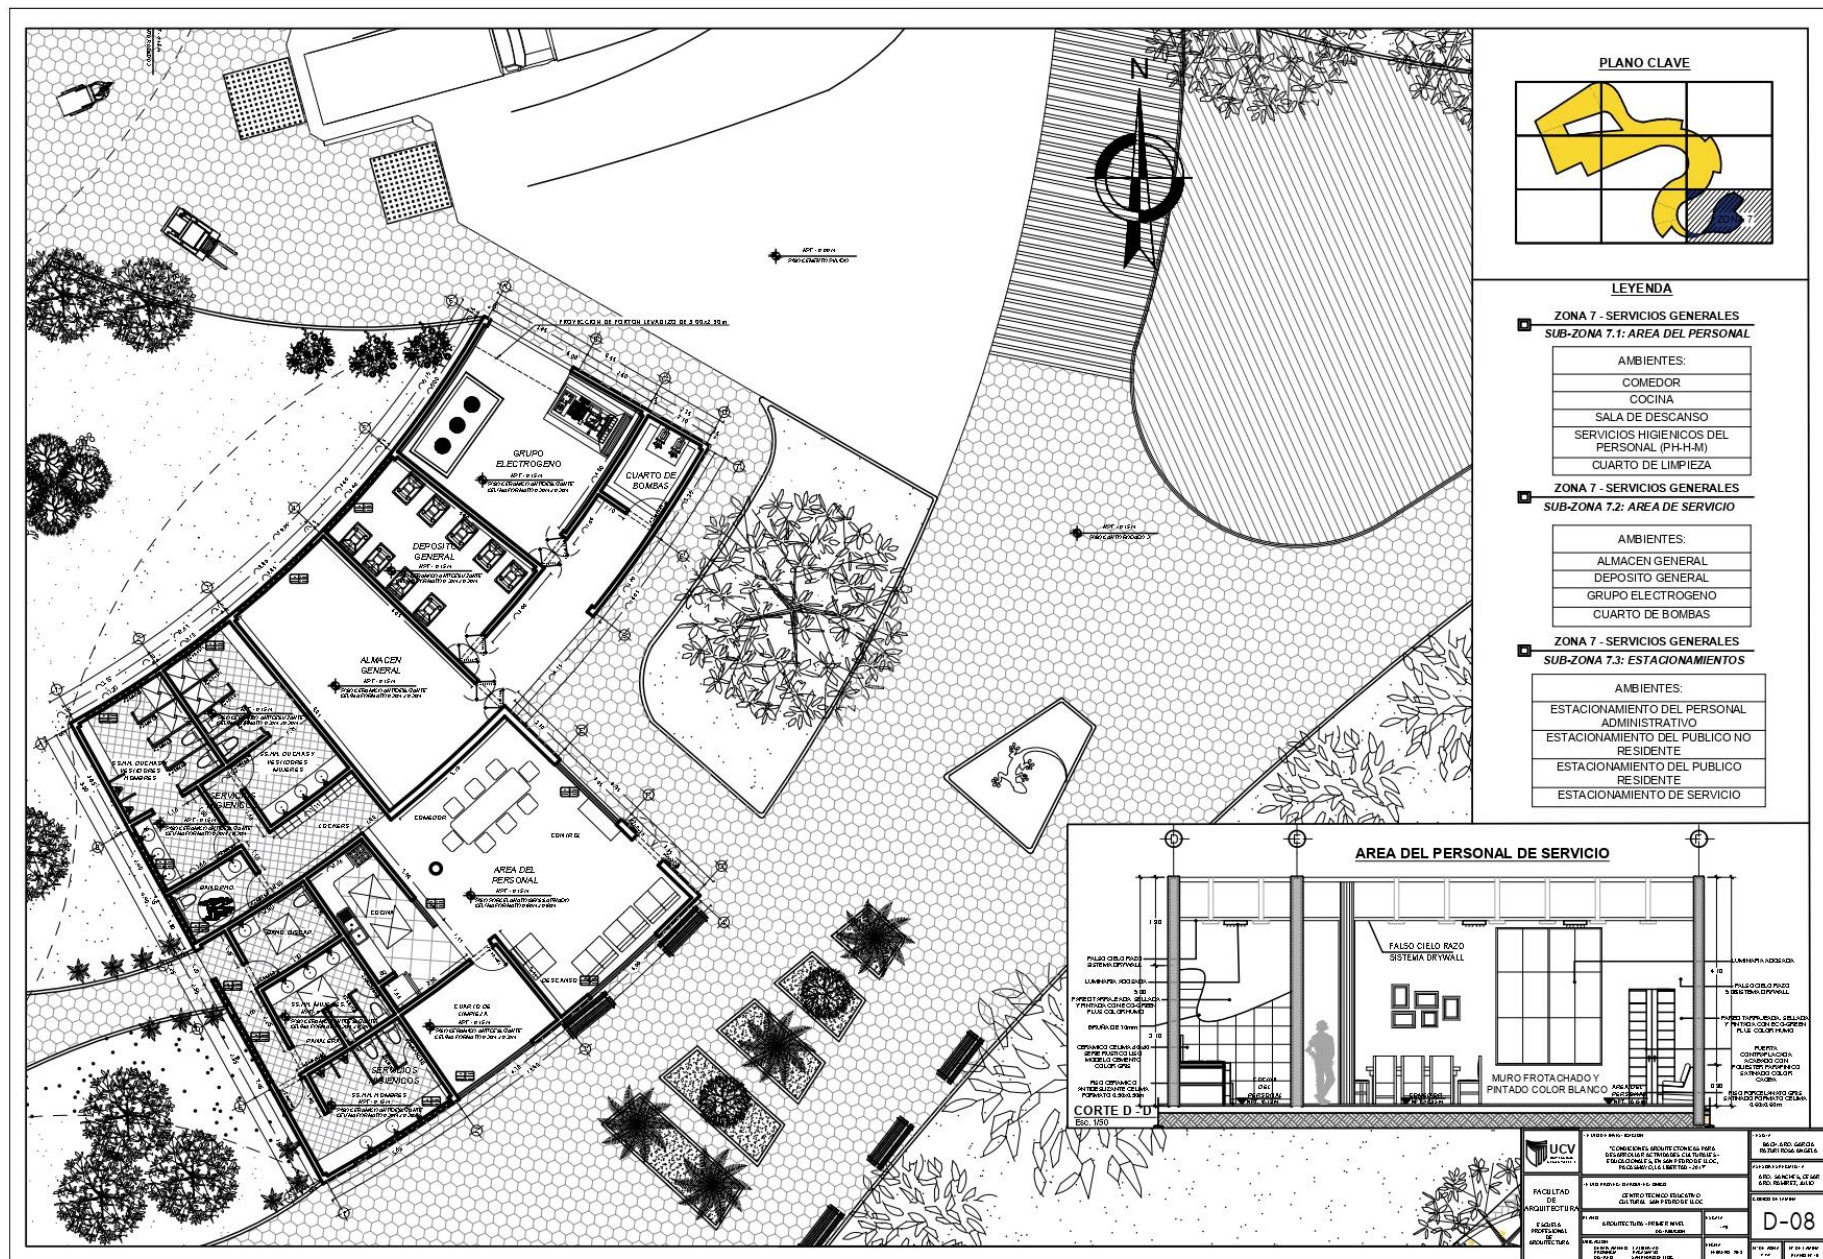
Plano de Desarrollo por Zonas - Plano N° 16 - Lamina N°: D - 08
